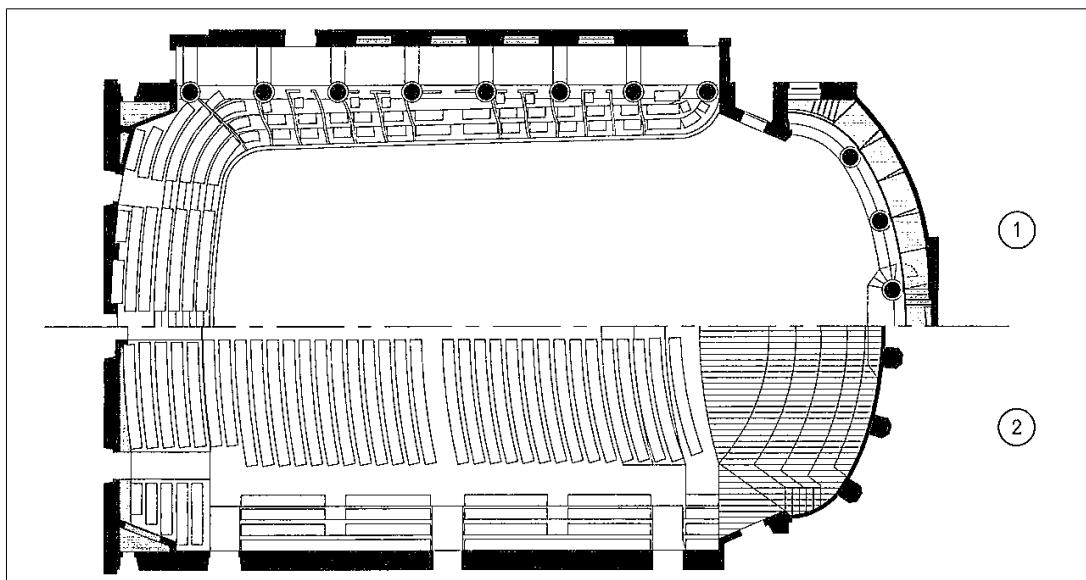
Grundriss mit Balkon (Beranek 2004, S. 178)
